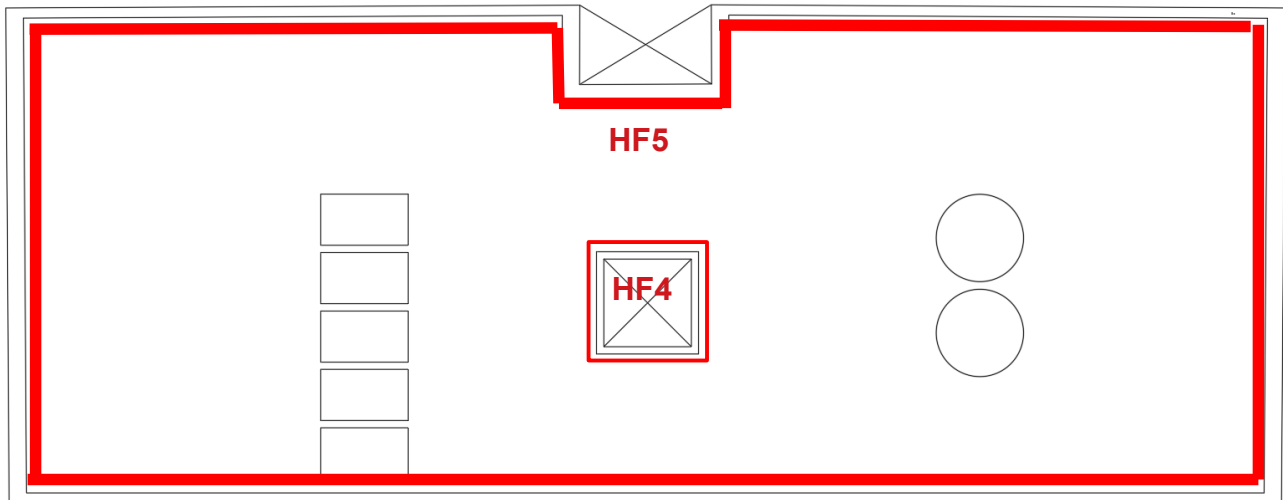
Localización Patología Humedad por Filtración Claraboya y Filtración Encuentro Murete Cubierta-Forjado cubierta (HF4 y HF5).
